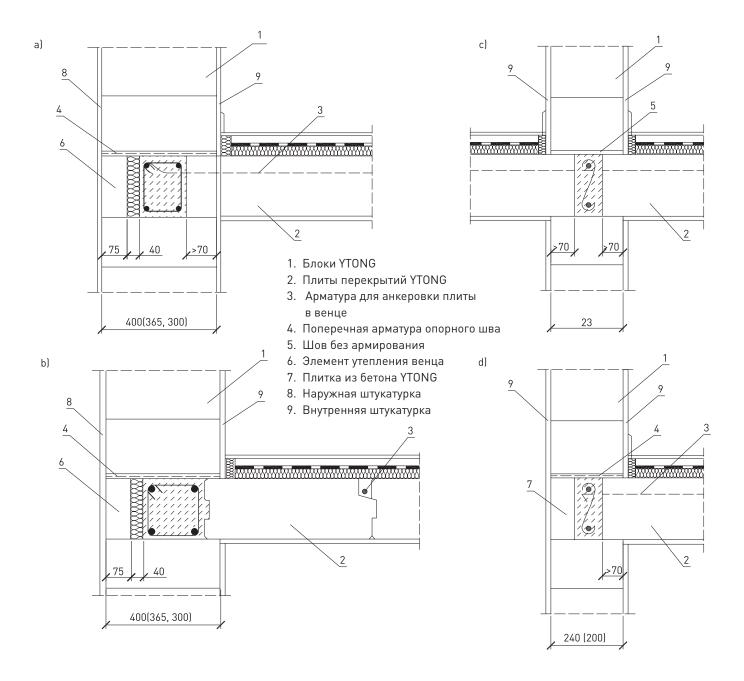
Опирание плит перекрытий из автоклавного газобетона YTONG: а) на наружную несущую стену, b) опирание на наружную стену плит, расположенных параллельно стене, с) опирание на внутреннюю несущую стену с двух сторон, d) опирание на внутреннюю несущую стену.
